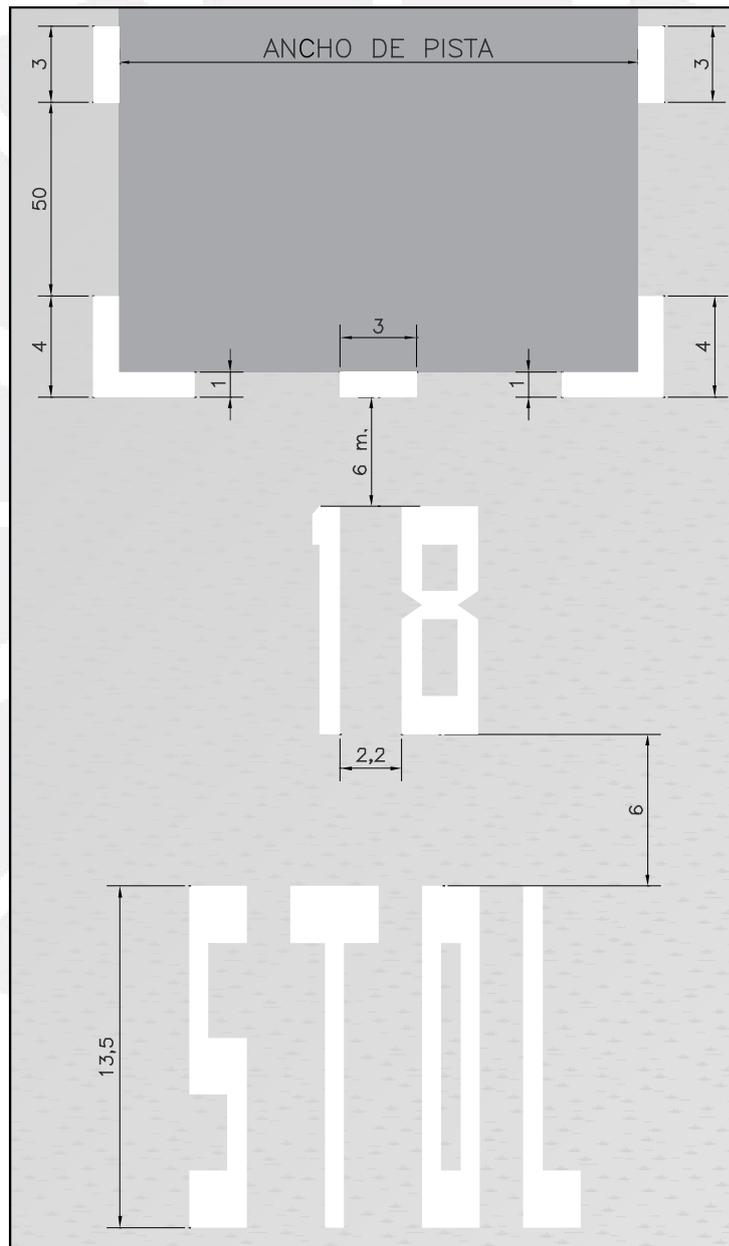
Señal de umbral STOL en pistas no pavimentadas
